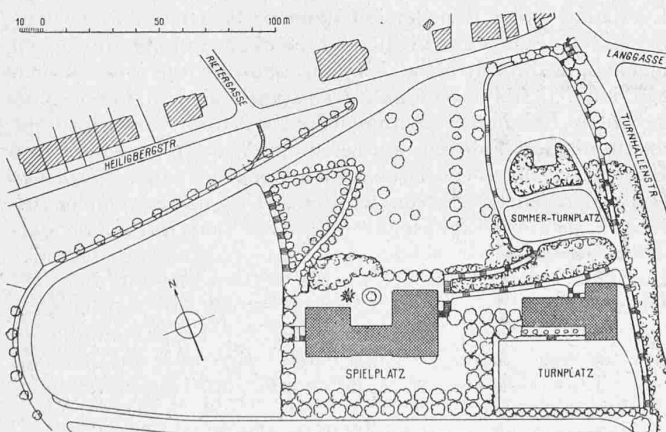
Lageplan von Schulhaus und Turnhalle. — 1:3000.
